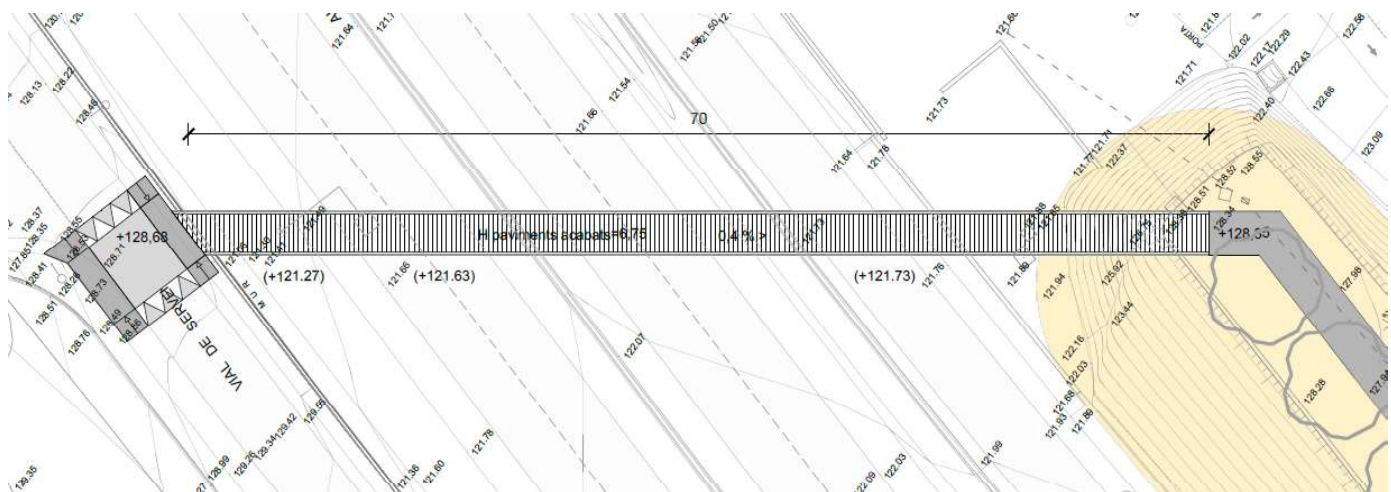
Planta de la passera prevista, aprofitant el talús existent.
